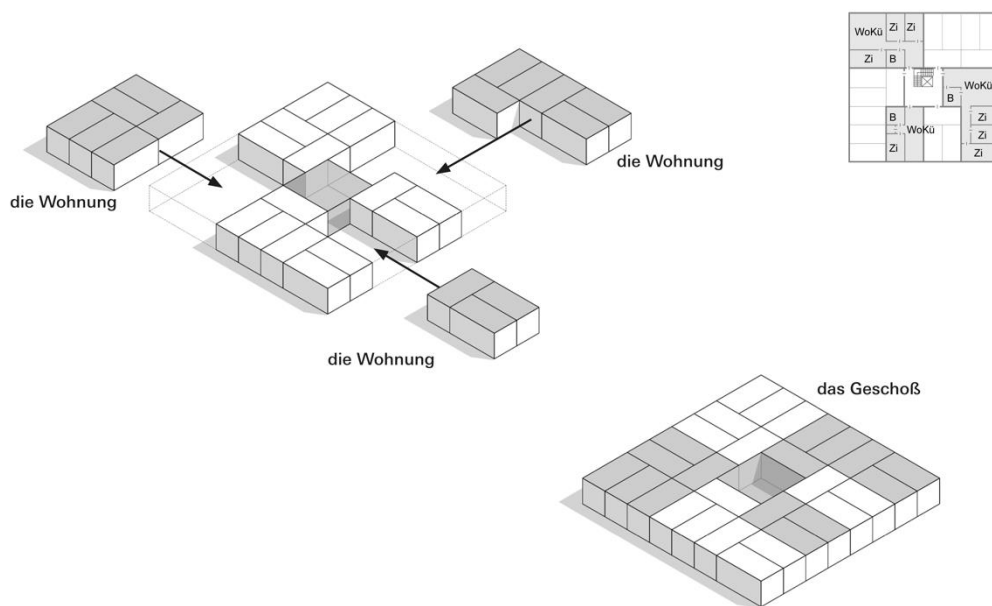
Typengeschoß für die Typologie Punkthaus mit Schemagrundriss
